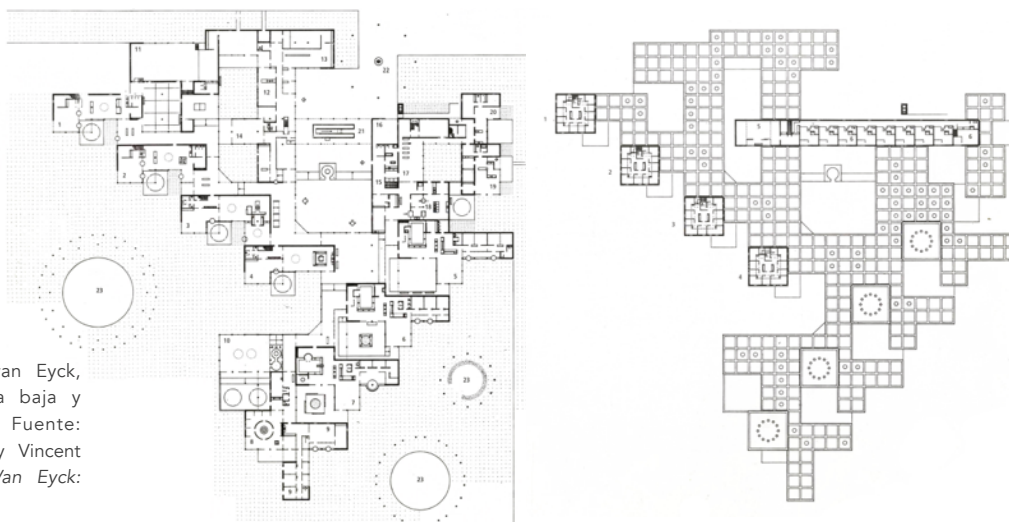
Aldo van Eyck, plano de planta baja y planta primera. Fuente: Aldo van Eyck y Vincent Ligtelijn, *Aldo Van Eyck: Works*.
